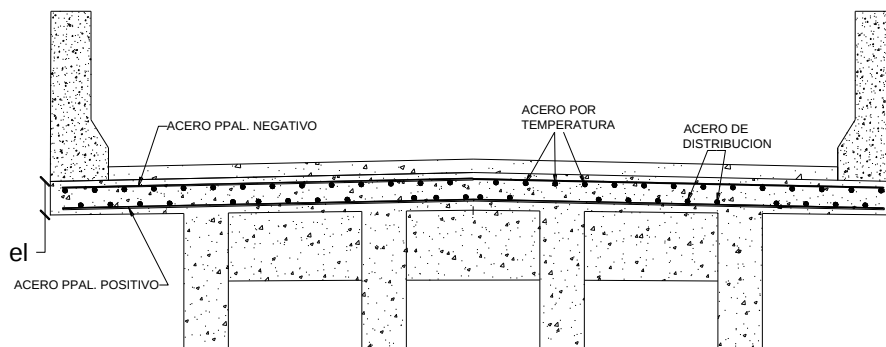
Aceros en la Sección transversal de la losa.
